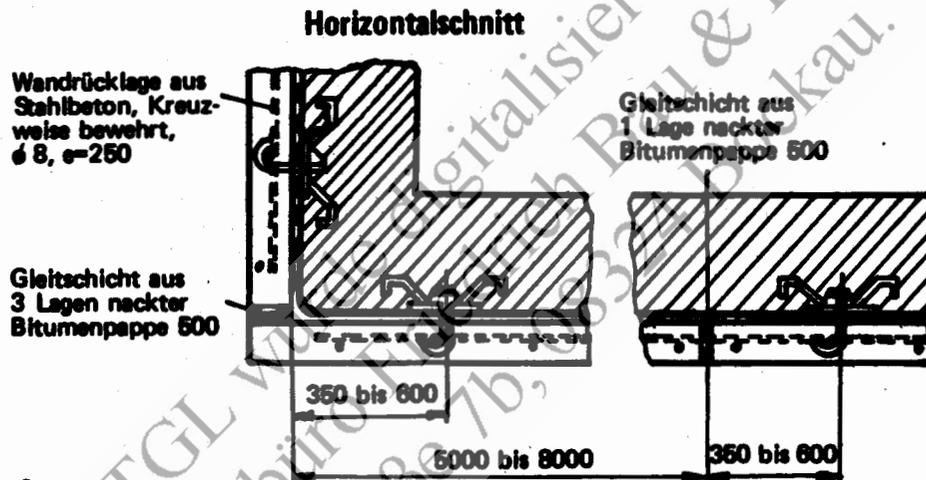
Aufteilung einer Wandrücklage aus Stahlbeton
